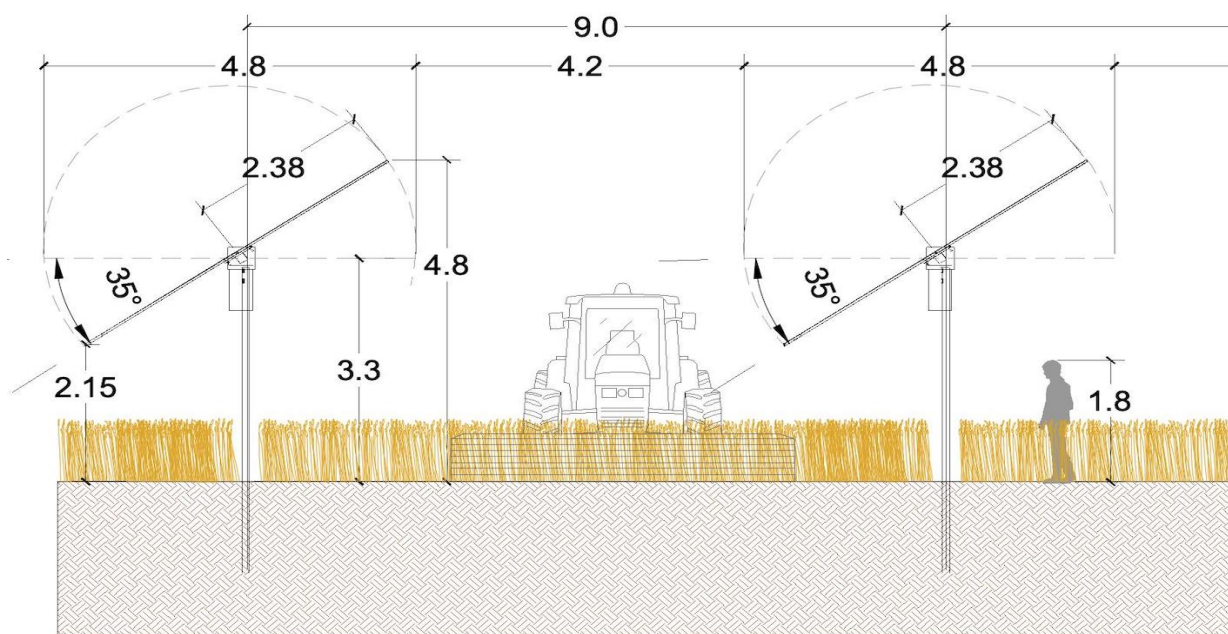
Sezione dell'impianto agrivoltico con pannelli tracker.
